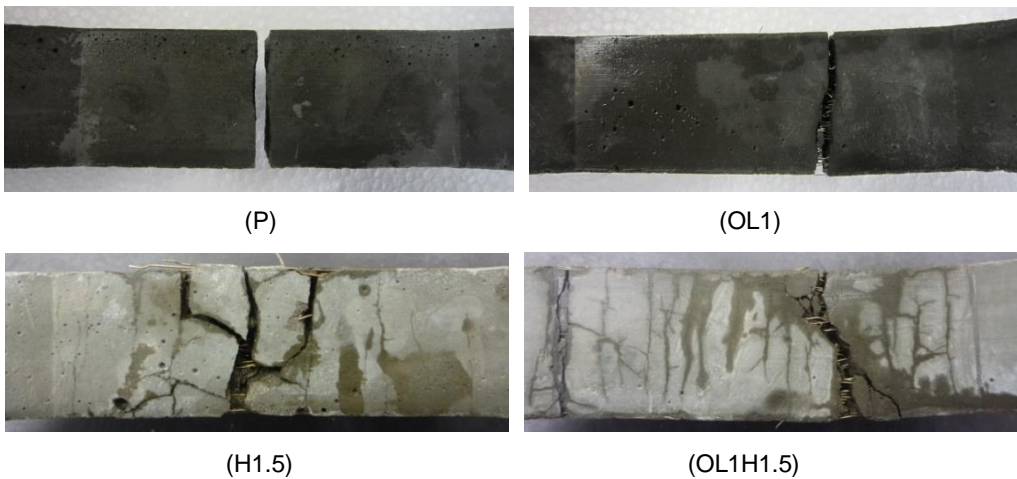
試験後の試験体のひび割れ形状と間隔
